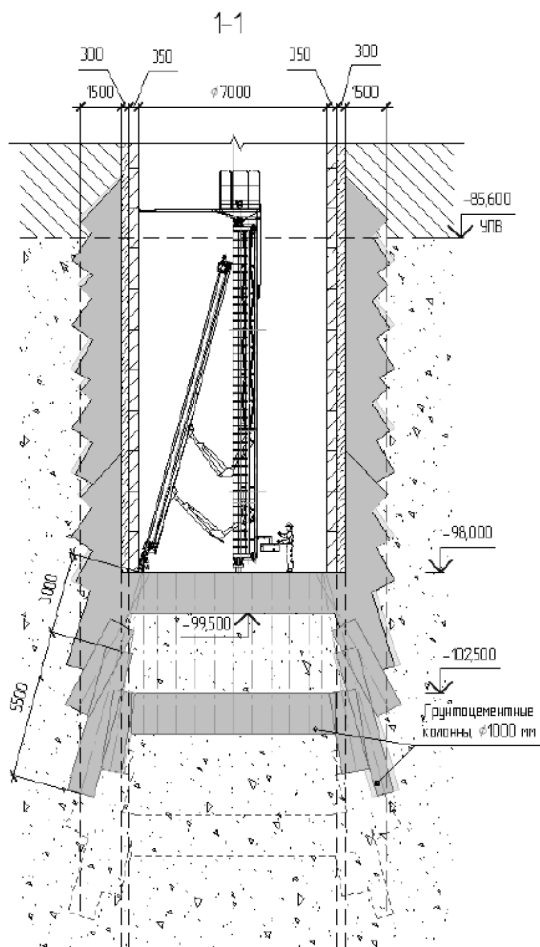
Створення ґрунтобетонної водоізоляційної оболонки навколо вертикального стовбуру [6]
